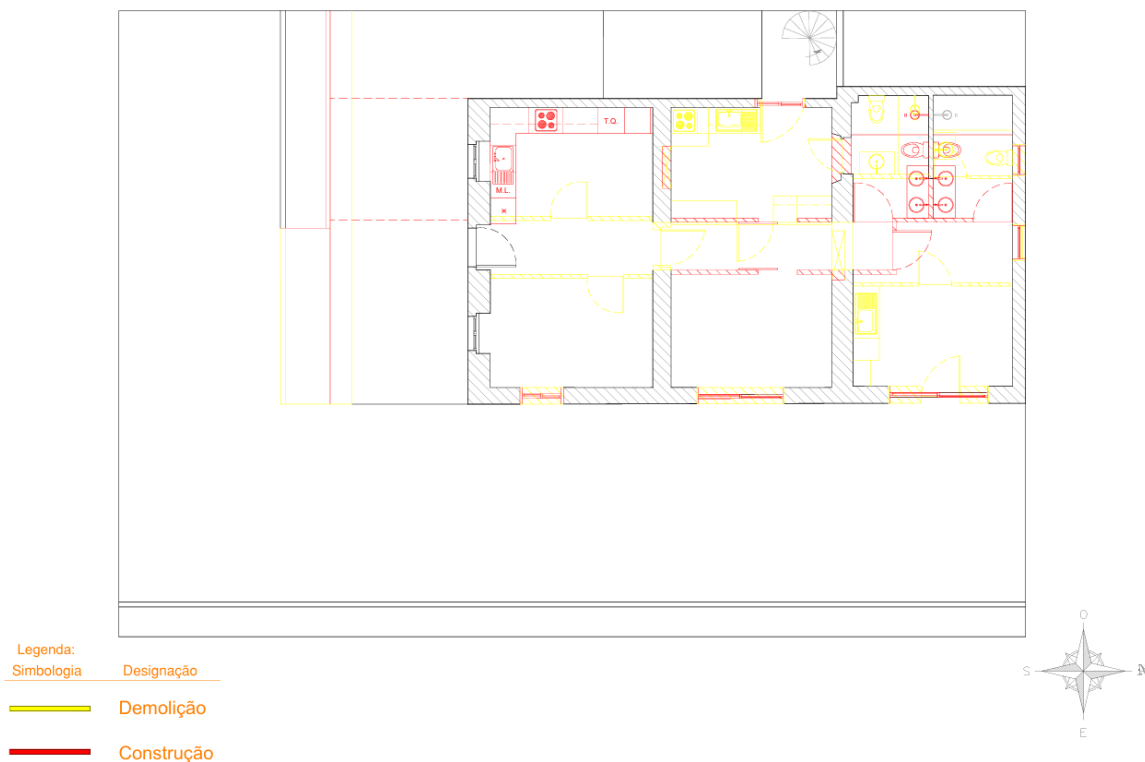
Planta de alterações (Fonte: Rita Giro, 2025)
